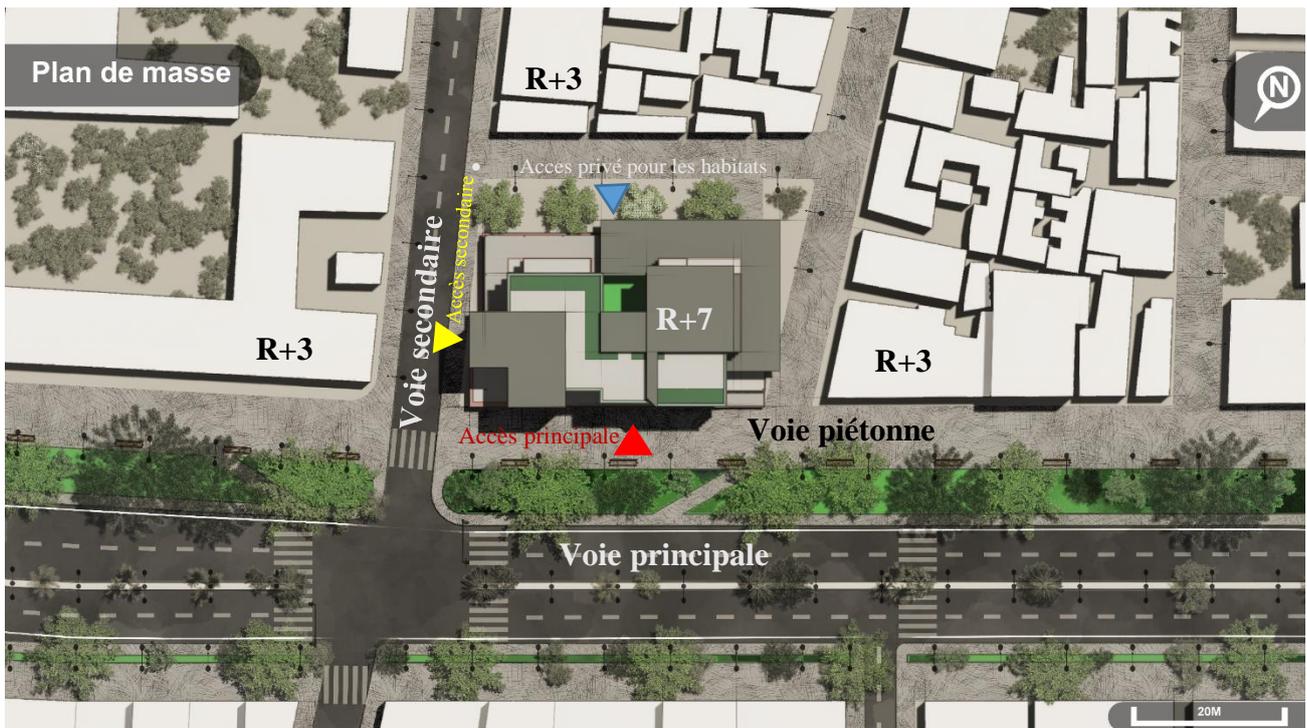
plan de masse de notre projet Source : l'auteur
